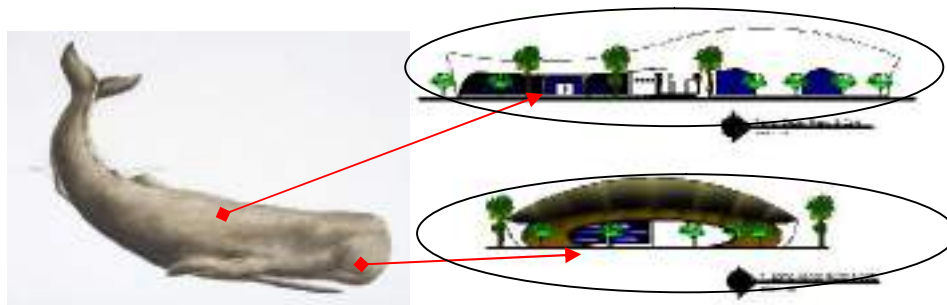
Kosep bentuk dan tampilan bangunan work shop
